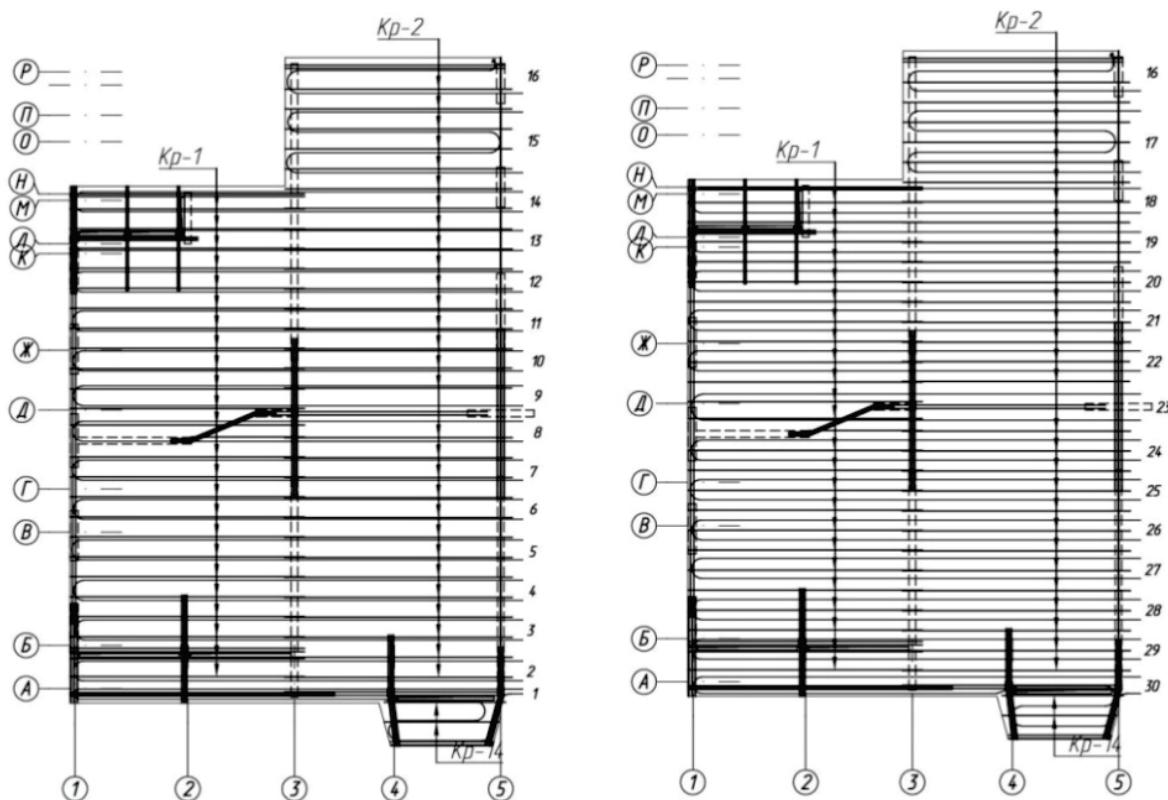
Схема електропрогрівання перекриття типового поверху будинку №3 по вул. Білогірській у м. Тернополі: а) по низу перекриття; б) по верху перекриття
